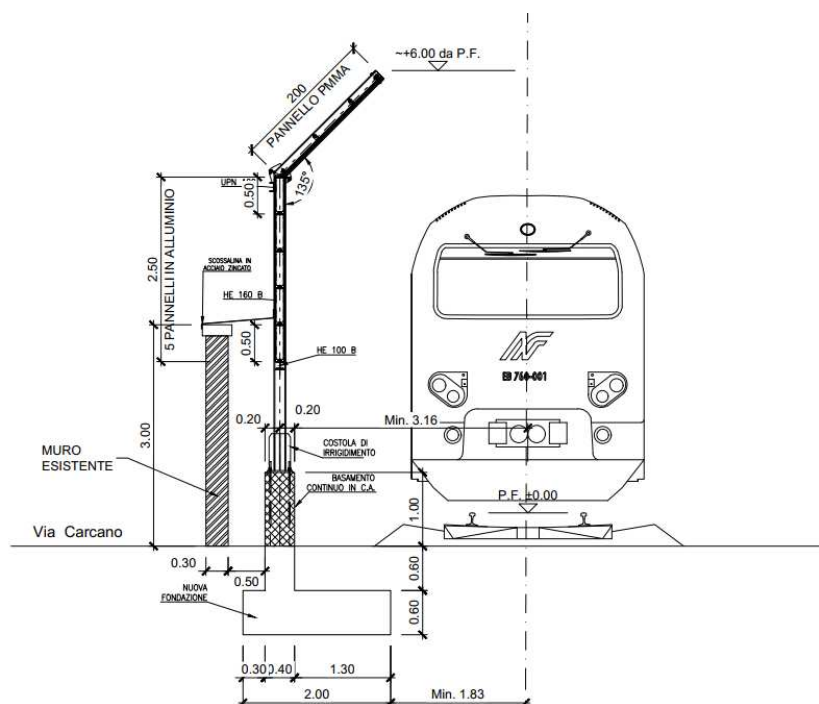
Sezione tipo – carpenteria fondazione per supporto barriera FOA
